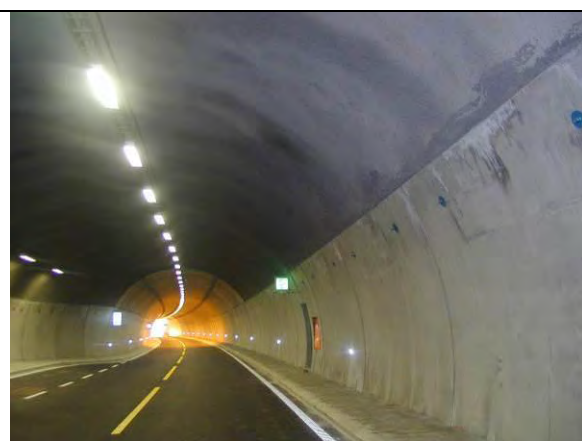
Tunnelhvelv T200 over havarinisje i nordgående løp
